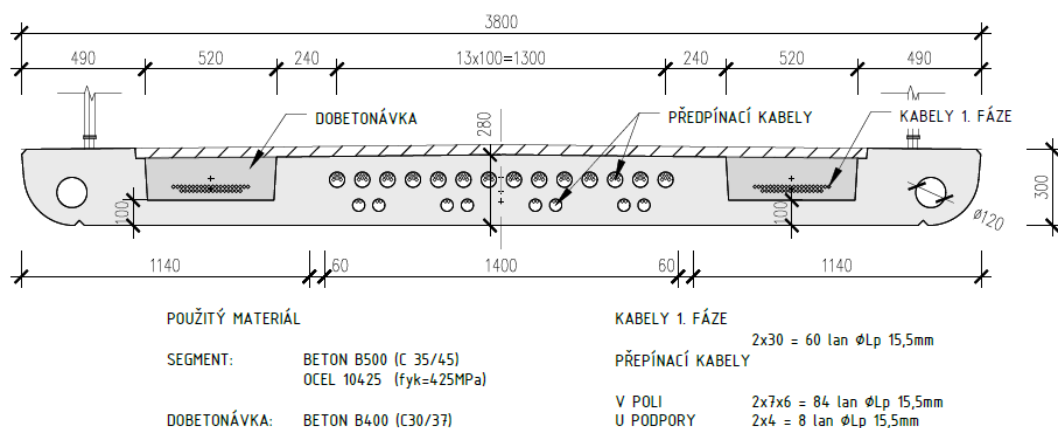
prefabrikovaný segment typu DS-Lv [3]
